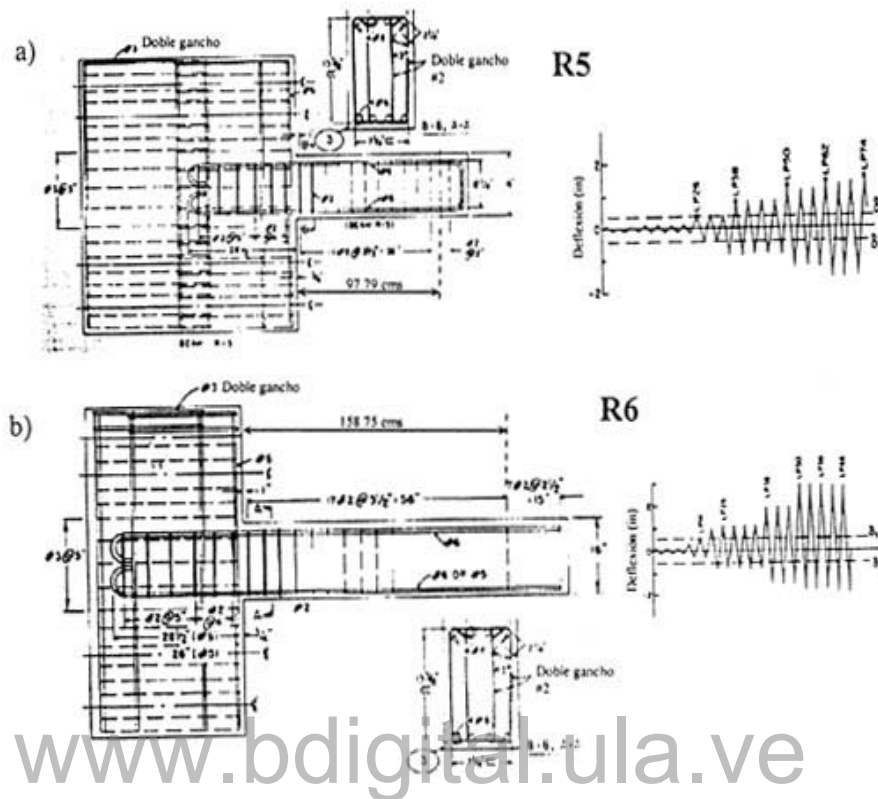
Geometría de las estructuras, detalles de las secciones transversales e historia de desplazamientos en los especímenes a) R5 y b) R6 ensayados por Betero et. al. [31]
